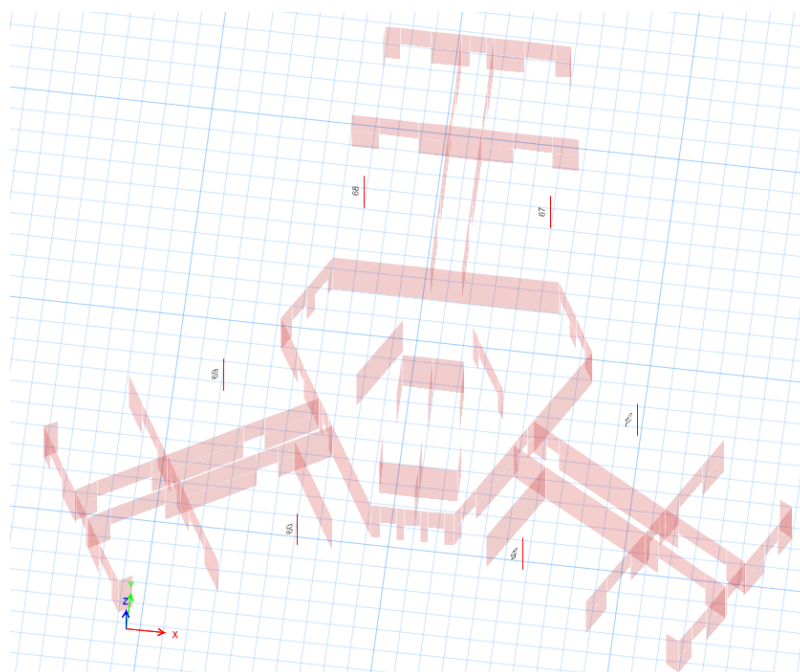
Армирование колонны на отм. 0.000м до отм. 4.95 м (Площадь полной арматуры)
